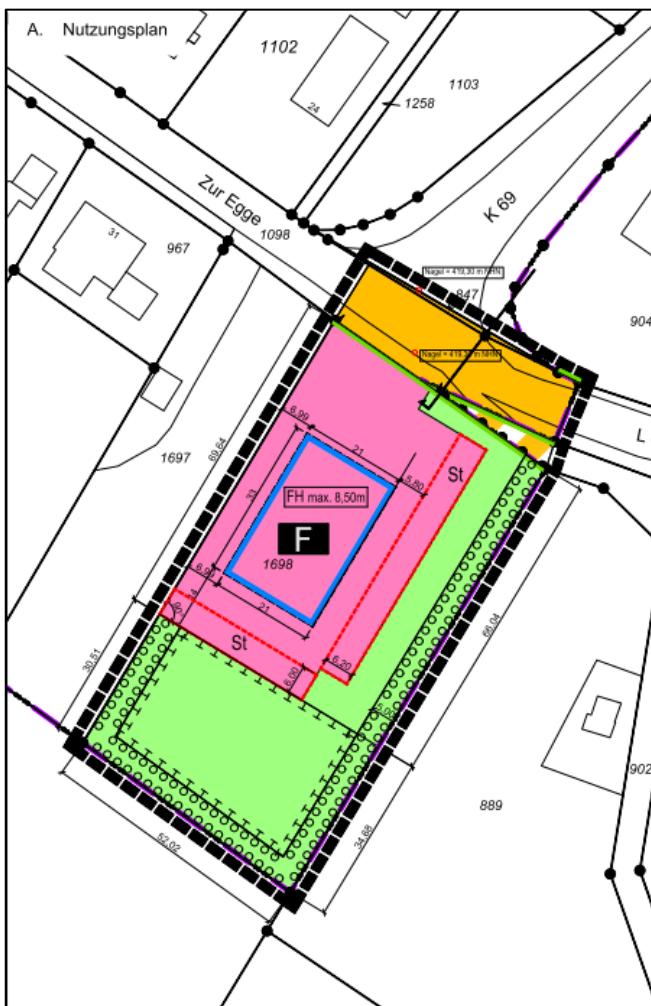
Ausschnitt aus dem Bebauungsplan Nr. 6 „Feuerwehrgerätehaus Meerhof“
